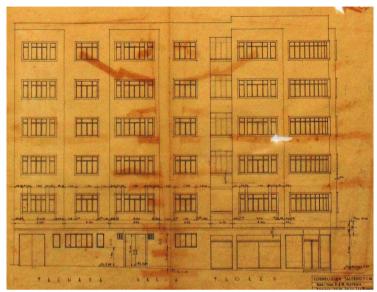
Edificio - Fachada hacia Las Flores. Código 5046, 1944
